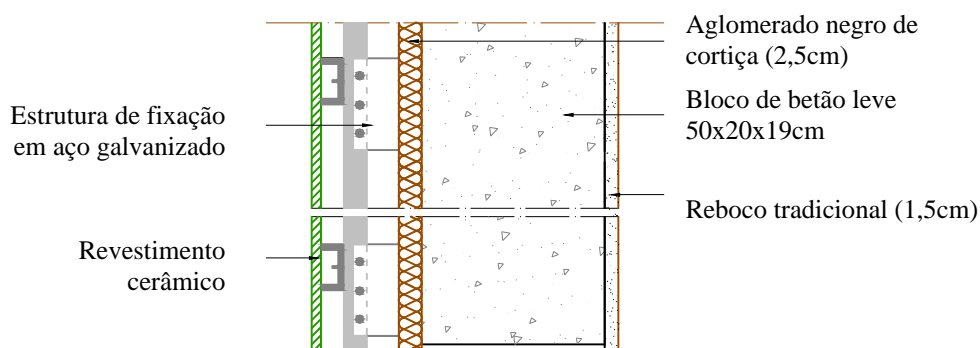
Parede ventilada com elemento de suporte em alvenaria de blocos de betão leve e revestimento cerâmico descontínuo fixado em estrutura metálica (Par5)
